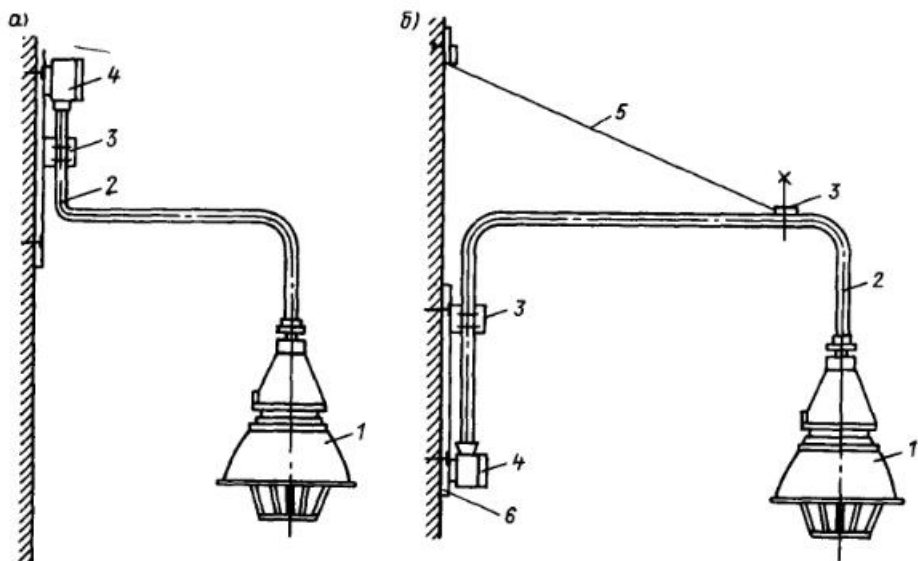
Крепление светильника на кронштейне при прокладке проводов в трубах: а — подвод проводов сверху, б — подвод проводов снизу при вылете кронштейна более 1 м
